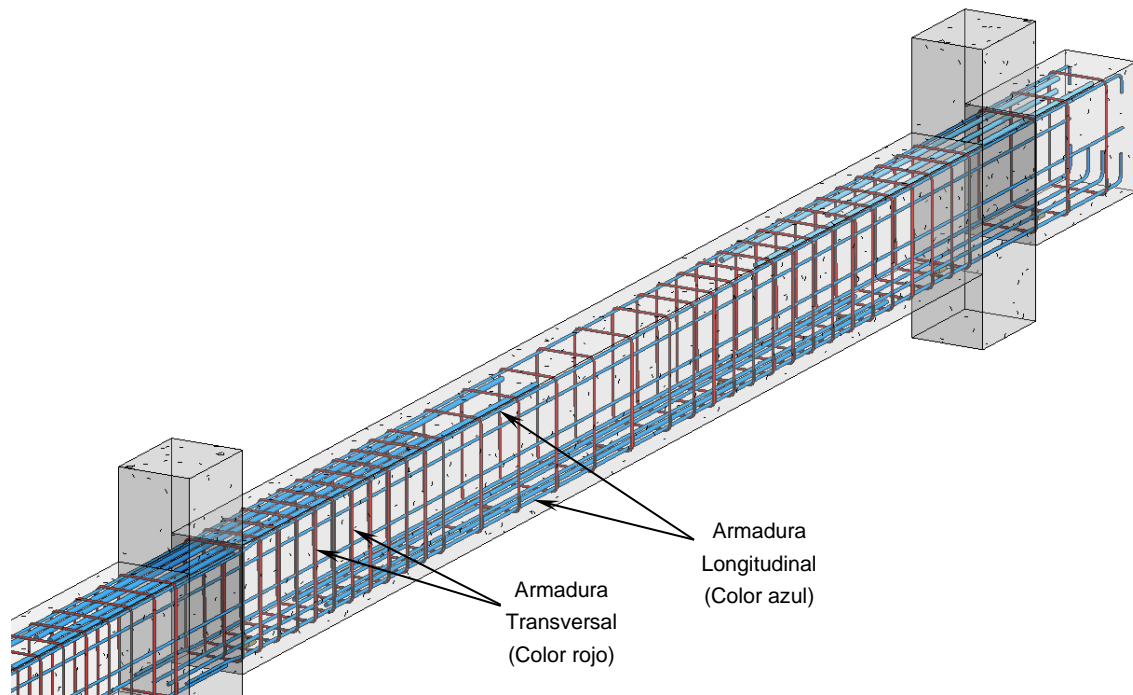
Clasificación de las armaduras pasivas (Vista 3D <https://skfb.ly/ovEtZ>)
